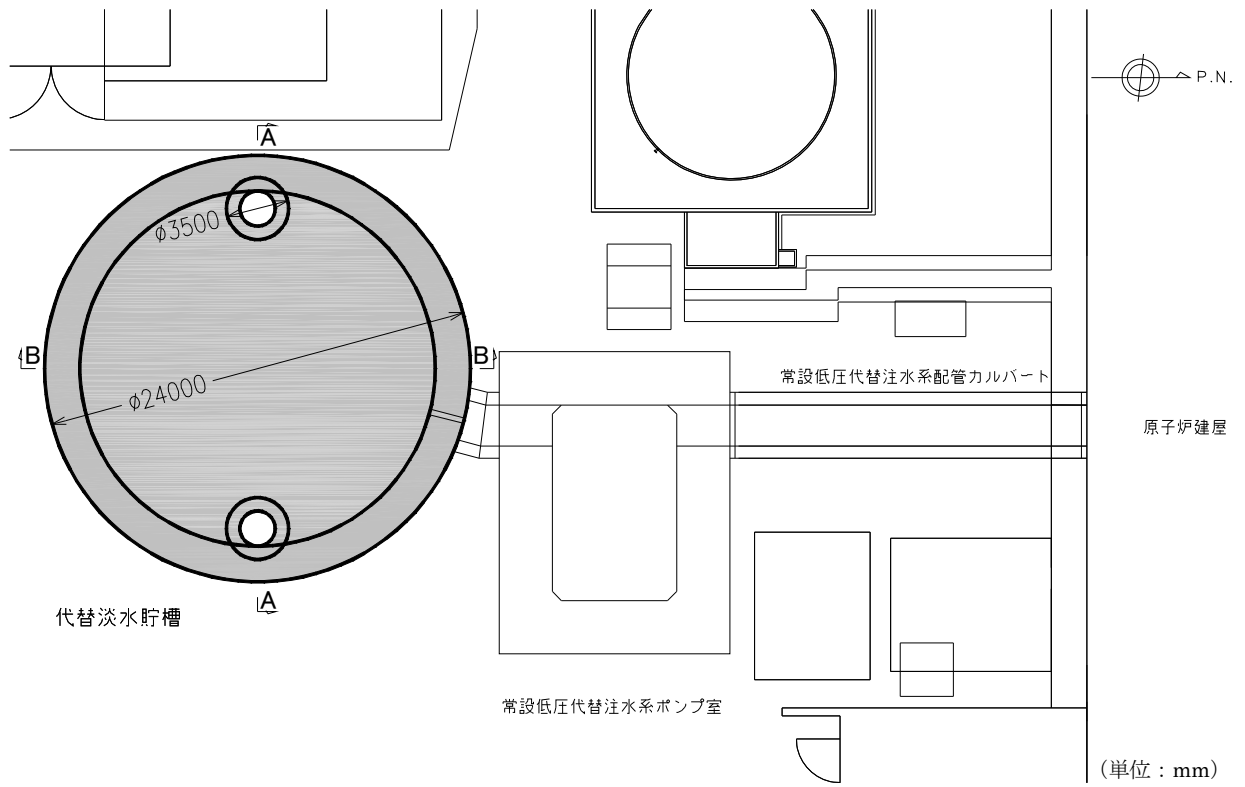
(2) 代替淡水貯槽 平面配置図 (拡大図)
